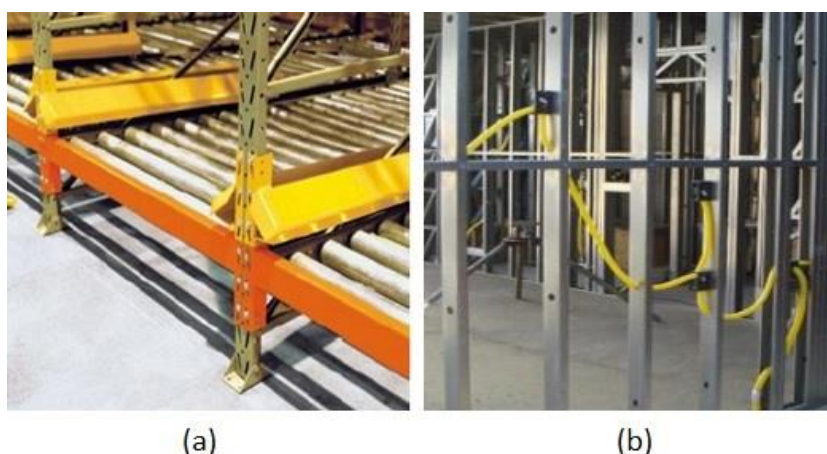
perfurações em perfis formados a frio (a) Encaixe das ligações em sistemas de armazenagem industrial (RIBEIRO, 2006); (b) Passagem de instalações em light steel frame (OLIVEIRA, 2017).
